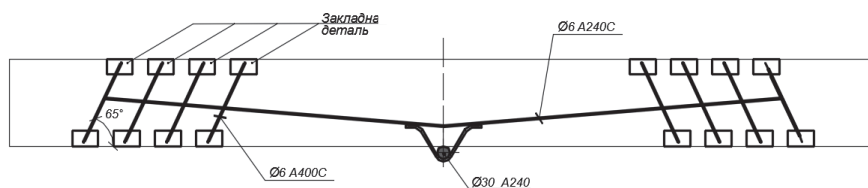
Схема підсилення балки БПП-ІІ-1 поздовжньою і поперечною паралельно розташованою зовнішньою арматурою
